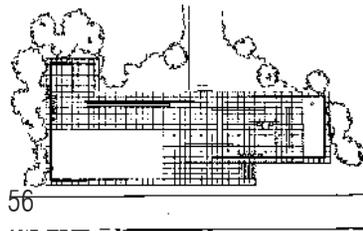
Planta del Pabellón de Mies van der Rohe, Barcelona
